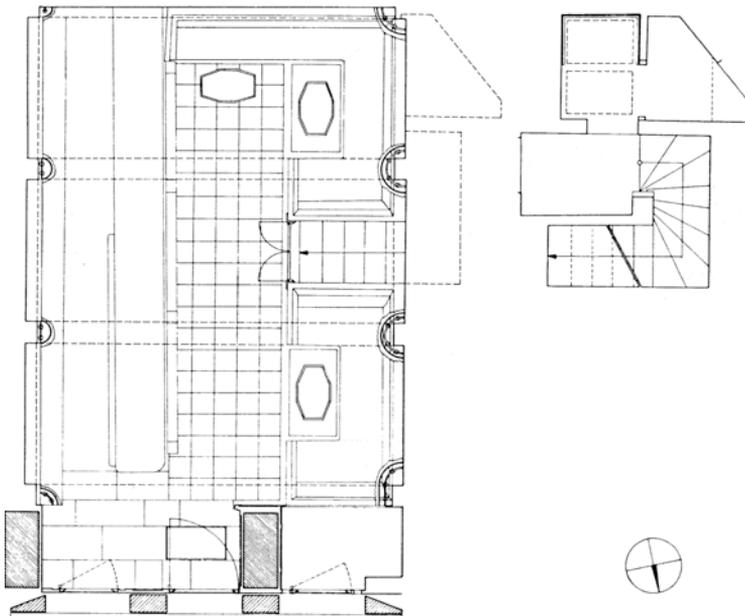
Loos Bar Grundriss, Zeichnung: ©Hermann Czech
